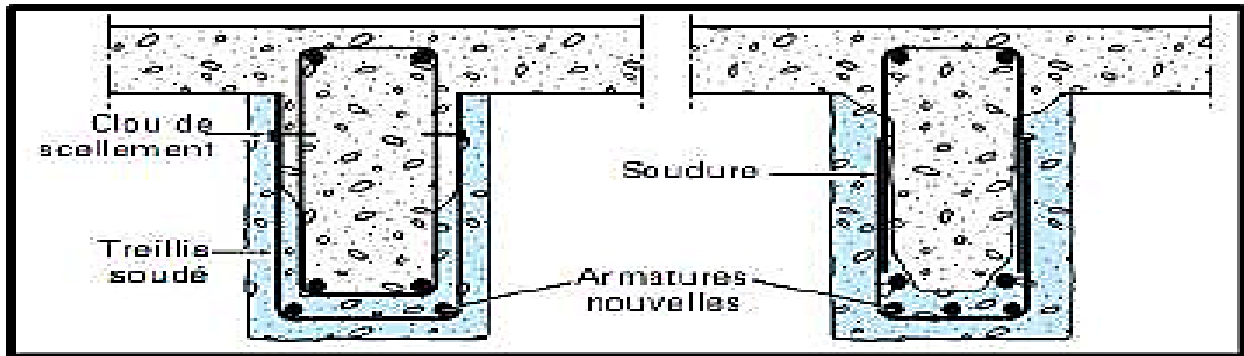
Figure VIII-III : Armatures supplémentaires en surépaisseur de poutre.
